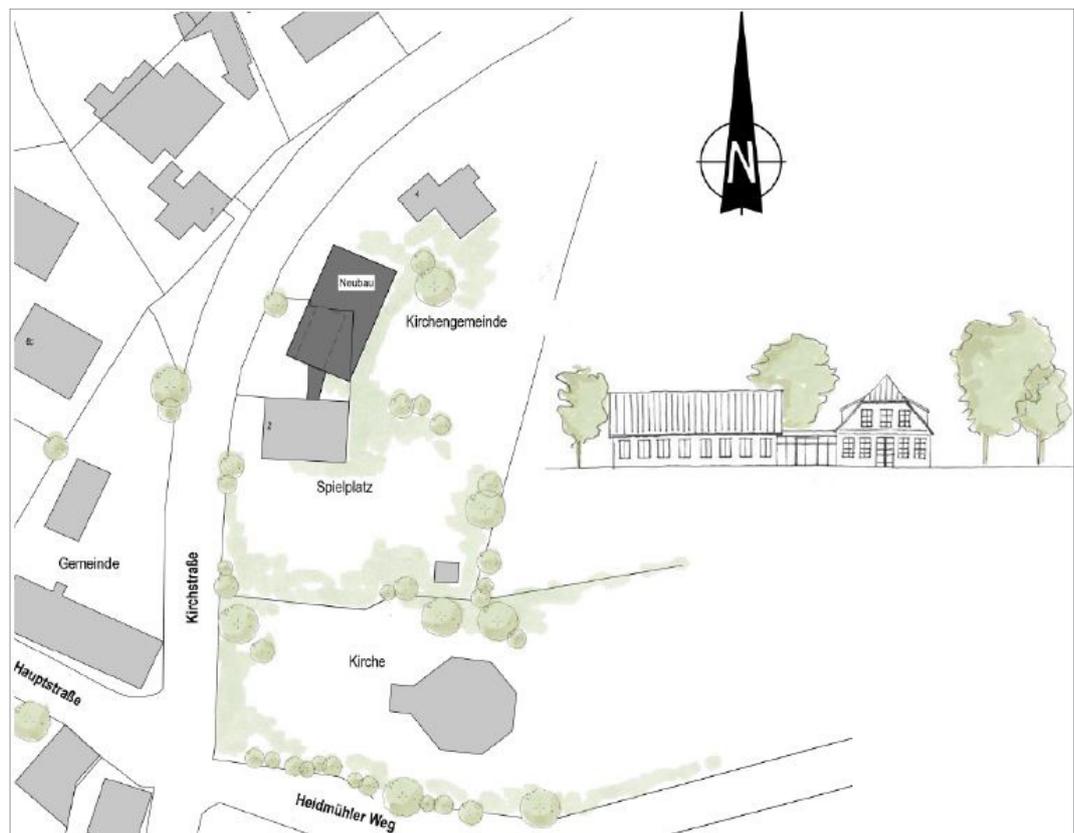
Quadrant 2 mit einem Saalneubau auf dem Areal der Kirchengemeinde; Quelle: Butzlaff Tewes
